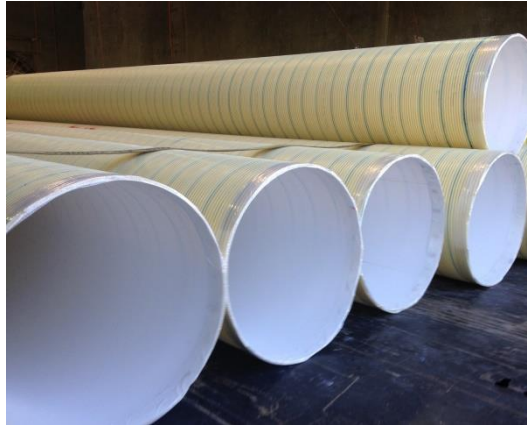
Cofragem de PVC para pilares antes da montagem [101]
